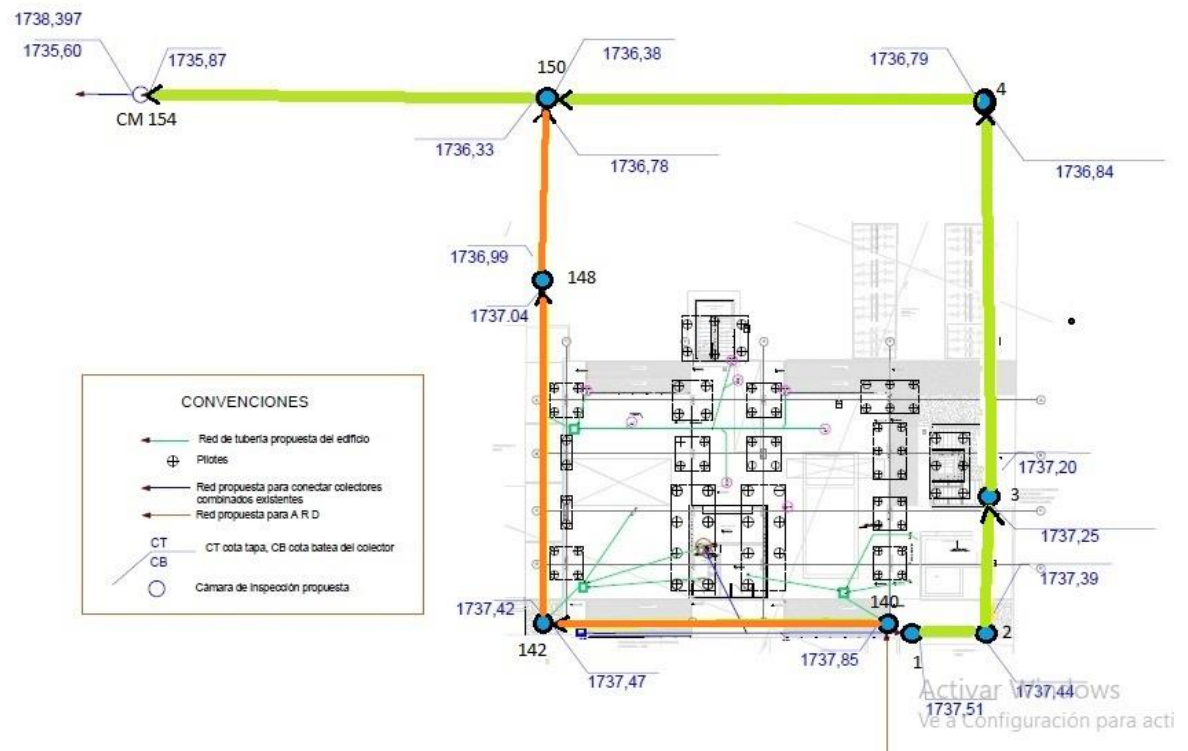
Plano de alcantarillado pluvial y sanitario agosto
